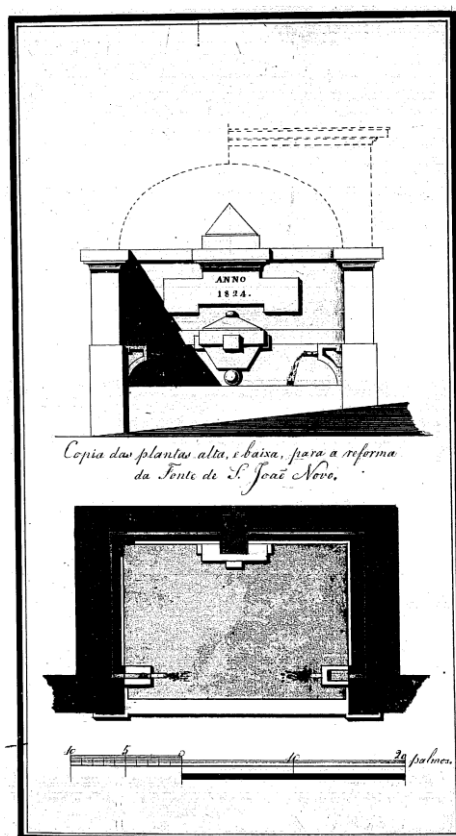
"Copia das plantas alta, e baixa, para a reforma da Fonte de S. João Novo" (1824) (A.H.M.P., Livro de Plantas, planta 50).
